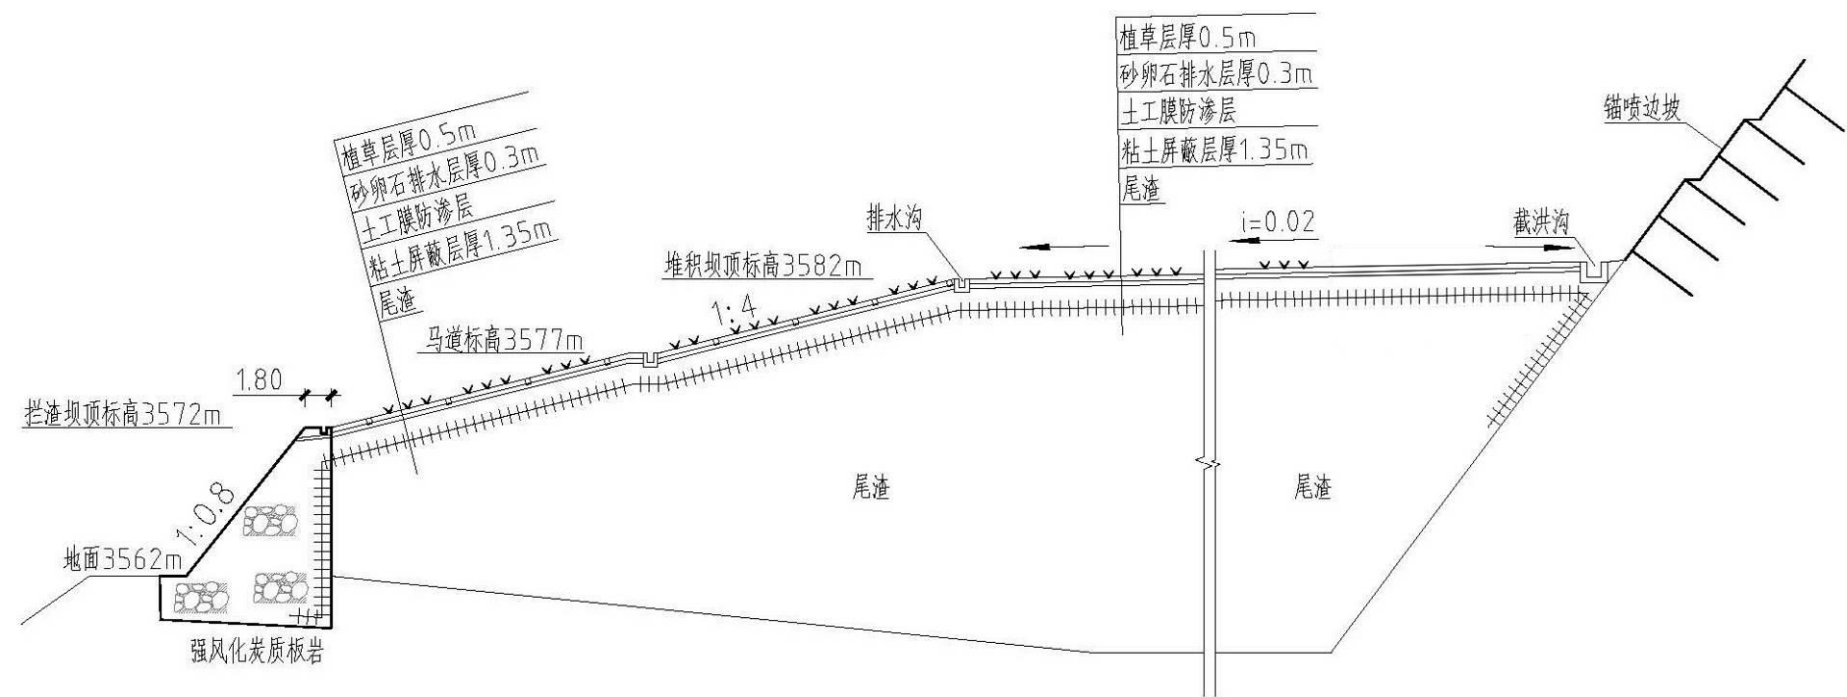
104 露天坑尾渣库治理方案剖面图
